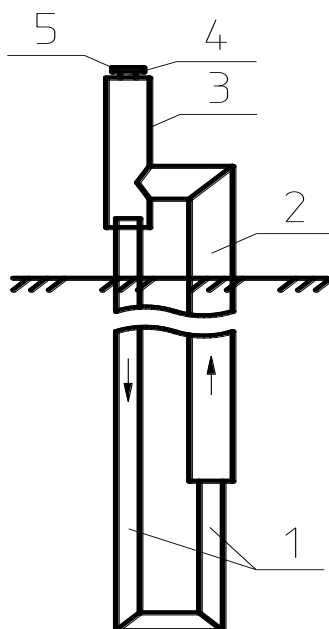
Схема автоматической установки для охлаждения ММГ С.И. Гапеева: 1, 2 – металлические трубы различного диаметра; 3 – труба расширителя, 4 – патрубок с резьбой, 5 – крышка
